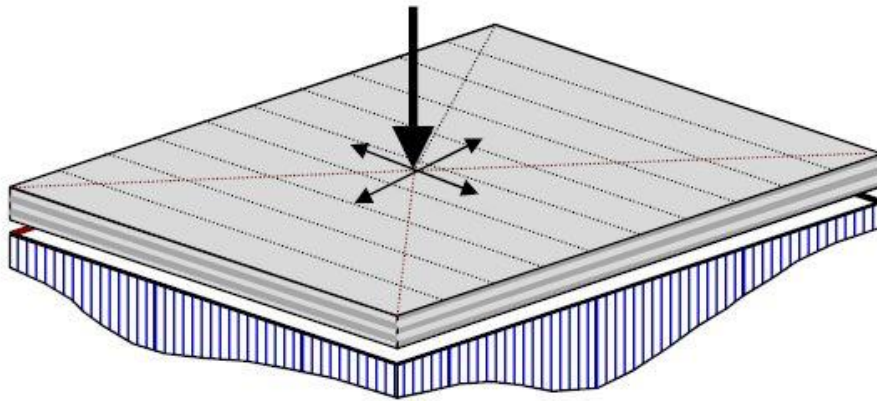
Effetto strutturale dell'elemento piastra [6]
